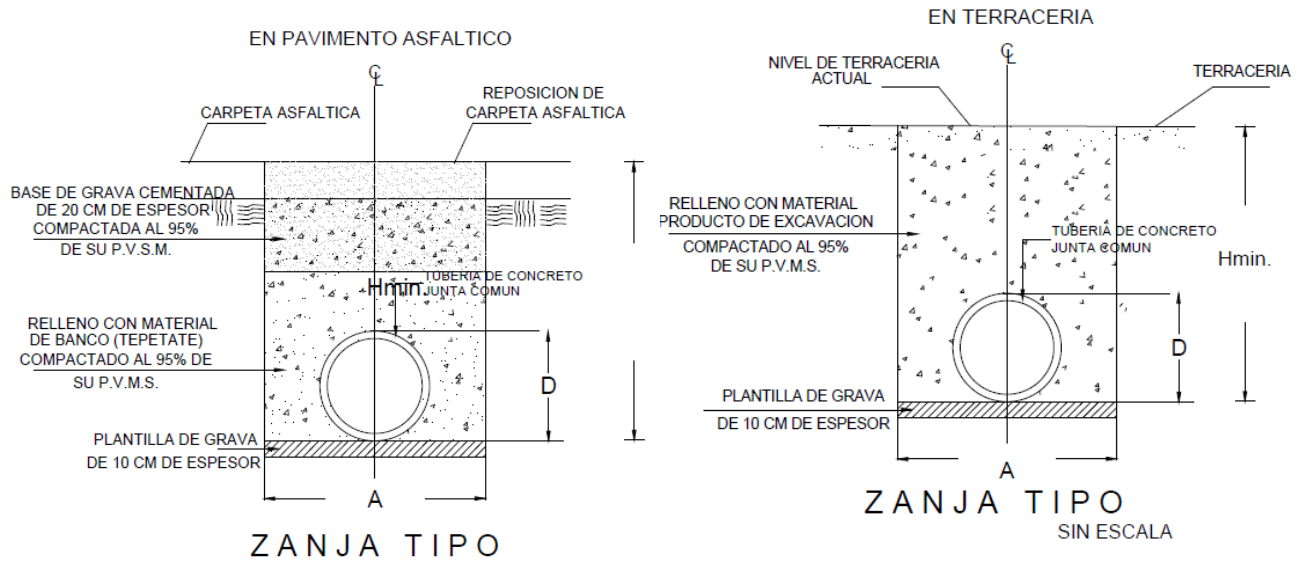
Datos de proyecto de drenaje pluvial. Fuente: plano de drenaje pluvial entregado por el departamento de proyectos de obras.
